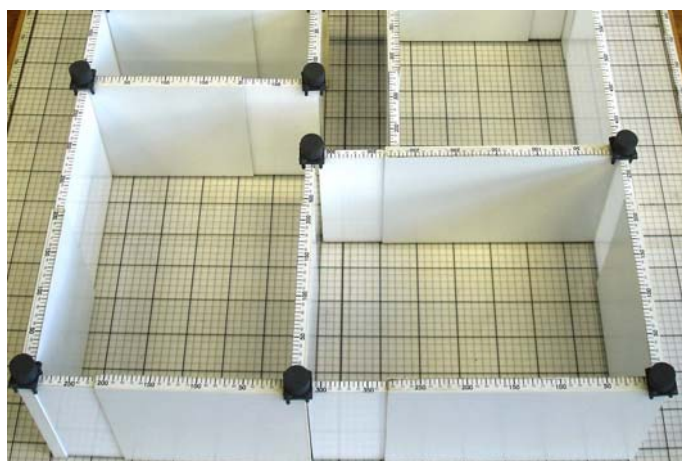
Exemplo de simulação das fundações da construção (Fonte: foto do autor).
